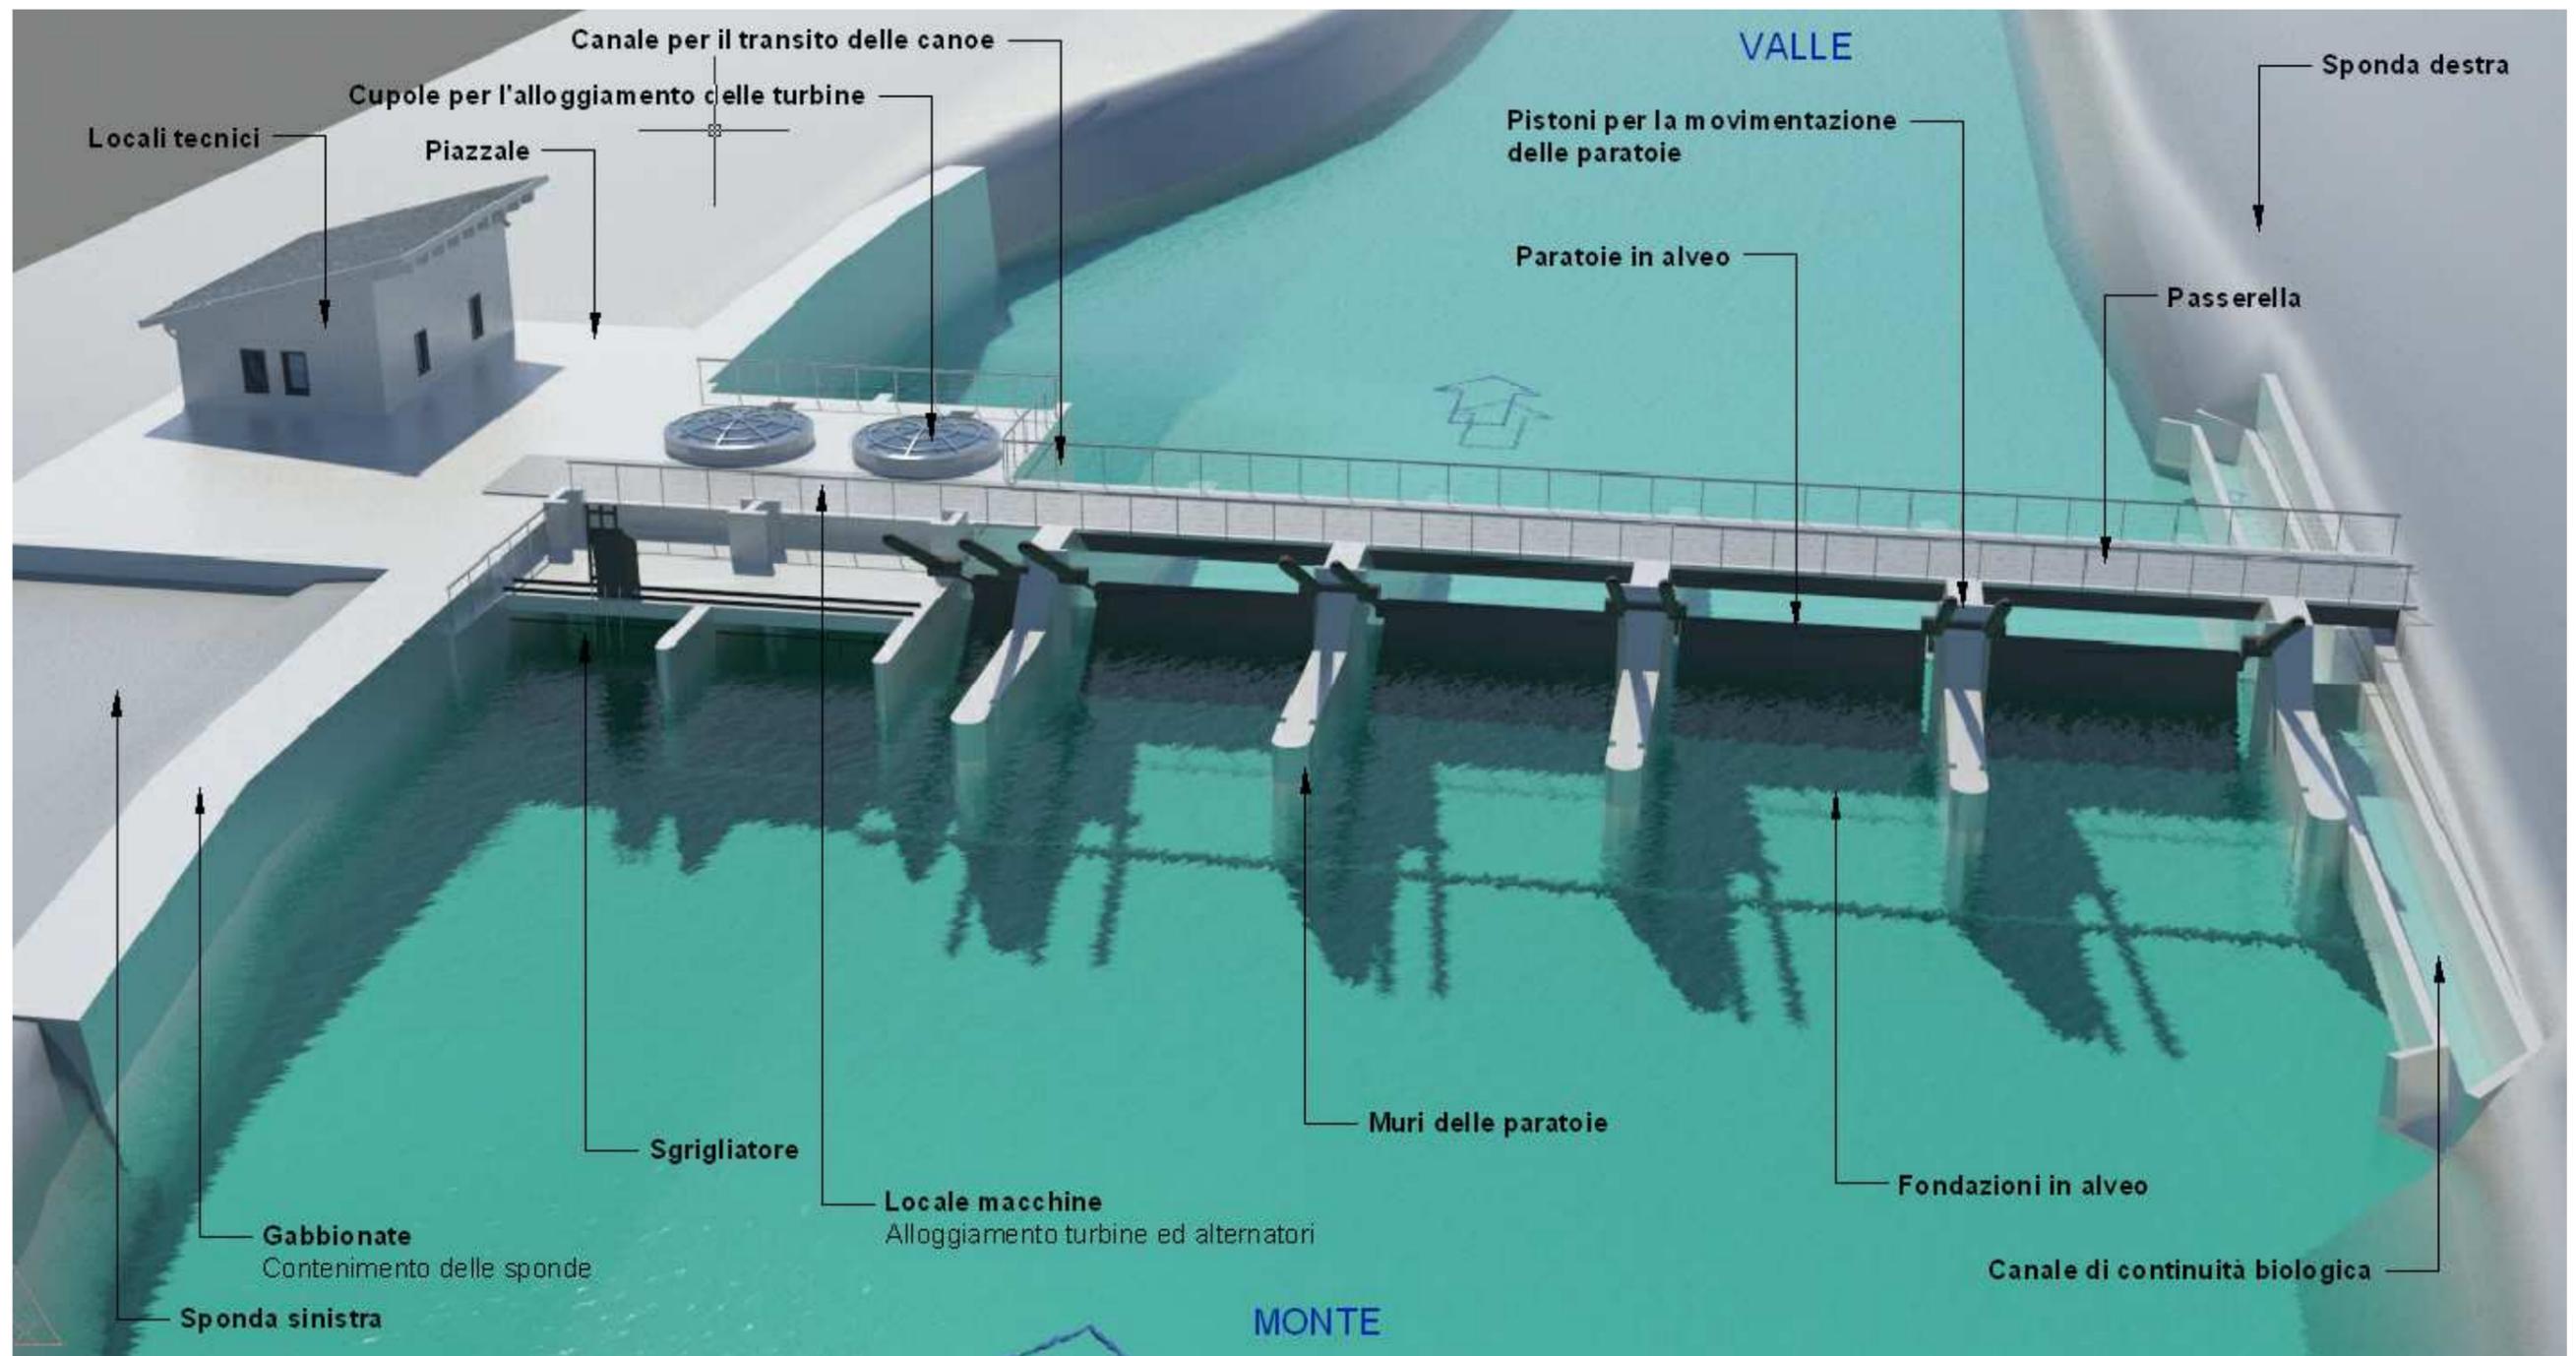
Ricostruzione volumetrica dell'impianto- vista da monte
